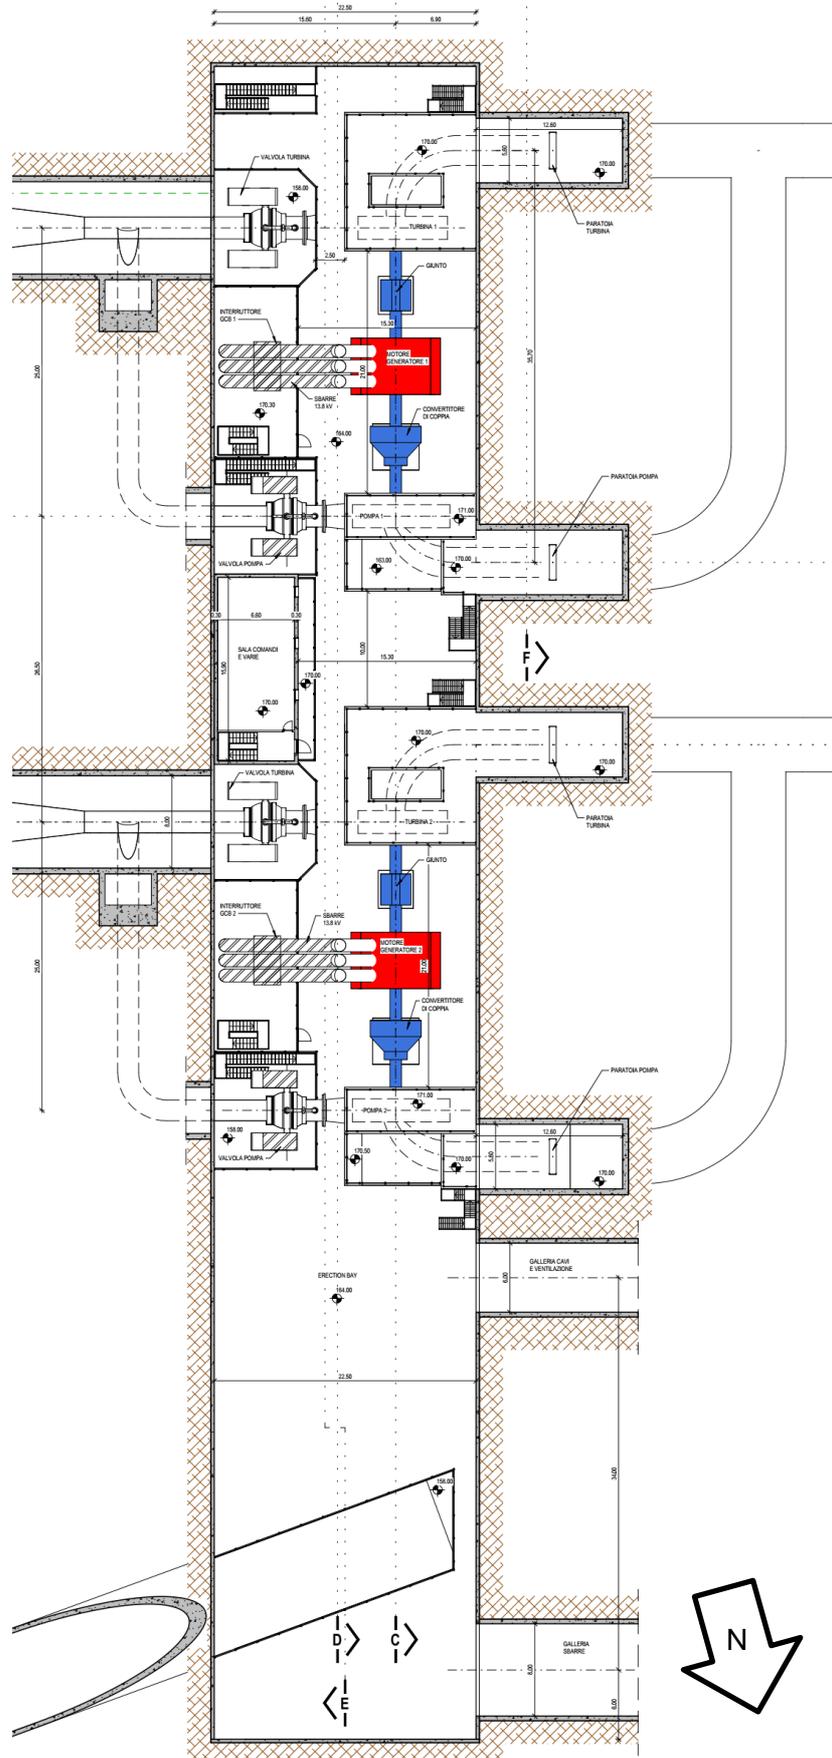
Pianta della centrale – dettaglio della sala macchine
